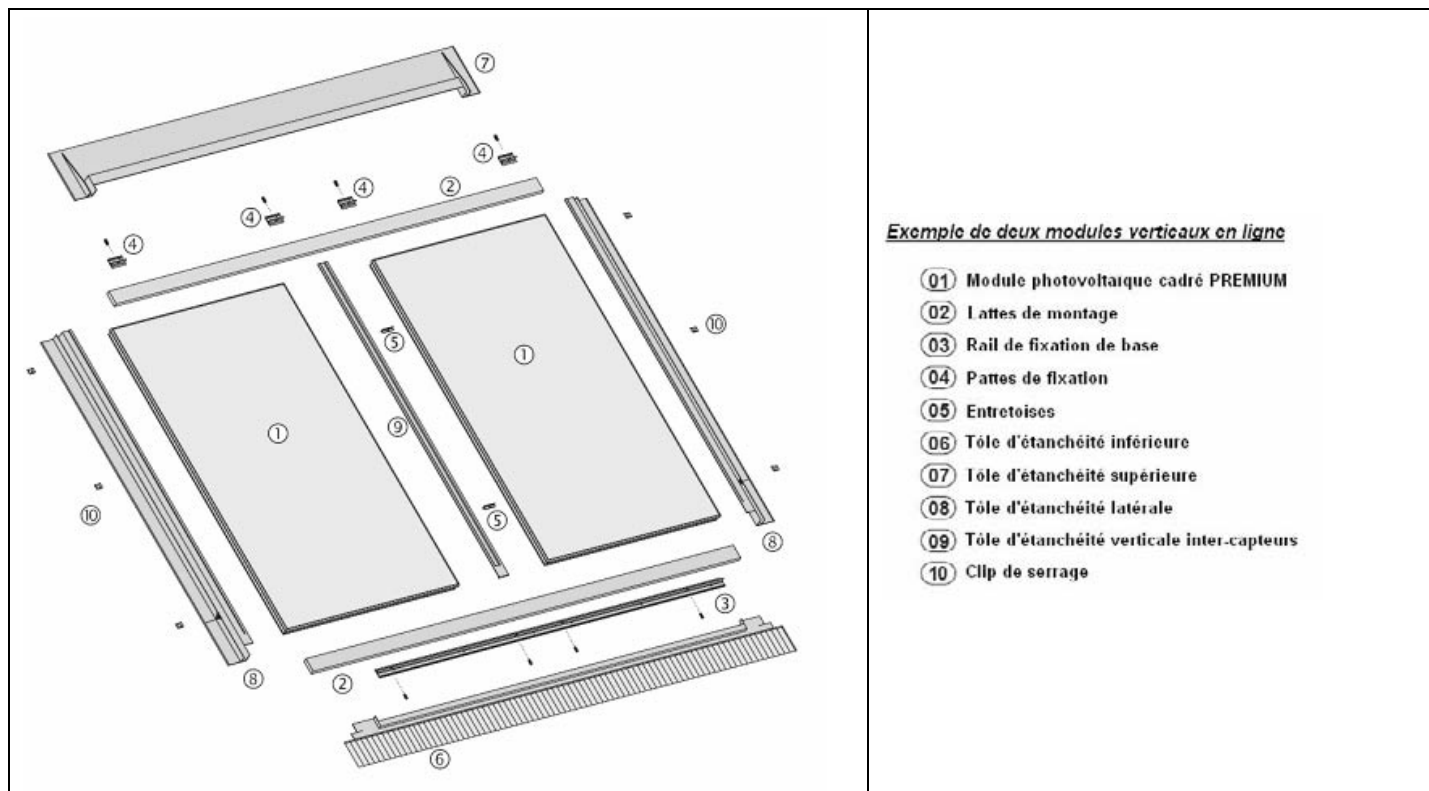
Vue d'ensemble éclatée et nomenclature du panneau photovoltaïque "PREMIUM S3xx-PMy" en incorporation toiture
